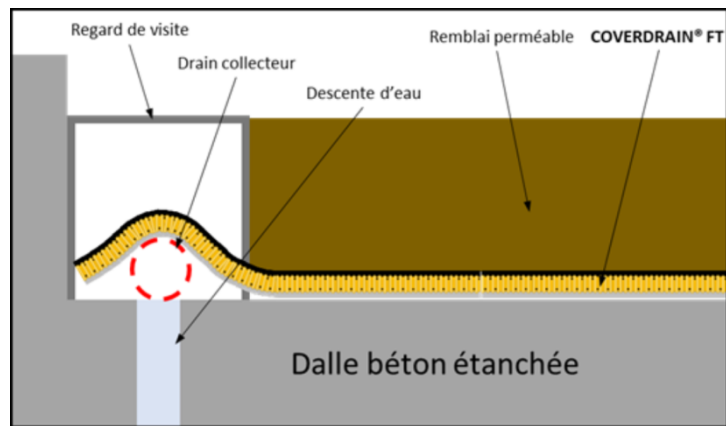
Vue en coupe du COVERDRAIN® FT sur dalle béton étanchée
